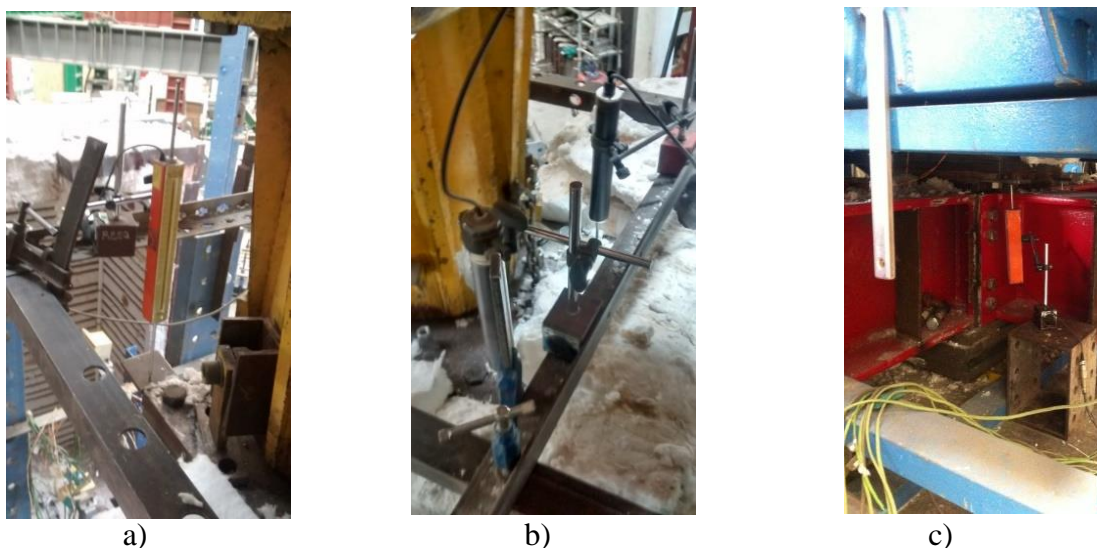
Instalação de LVDT's a) no centro do pórtico, na parte superior b) no topo do pilar c) na base do pilar
